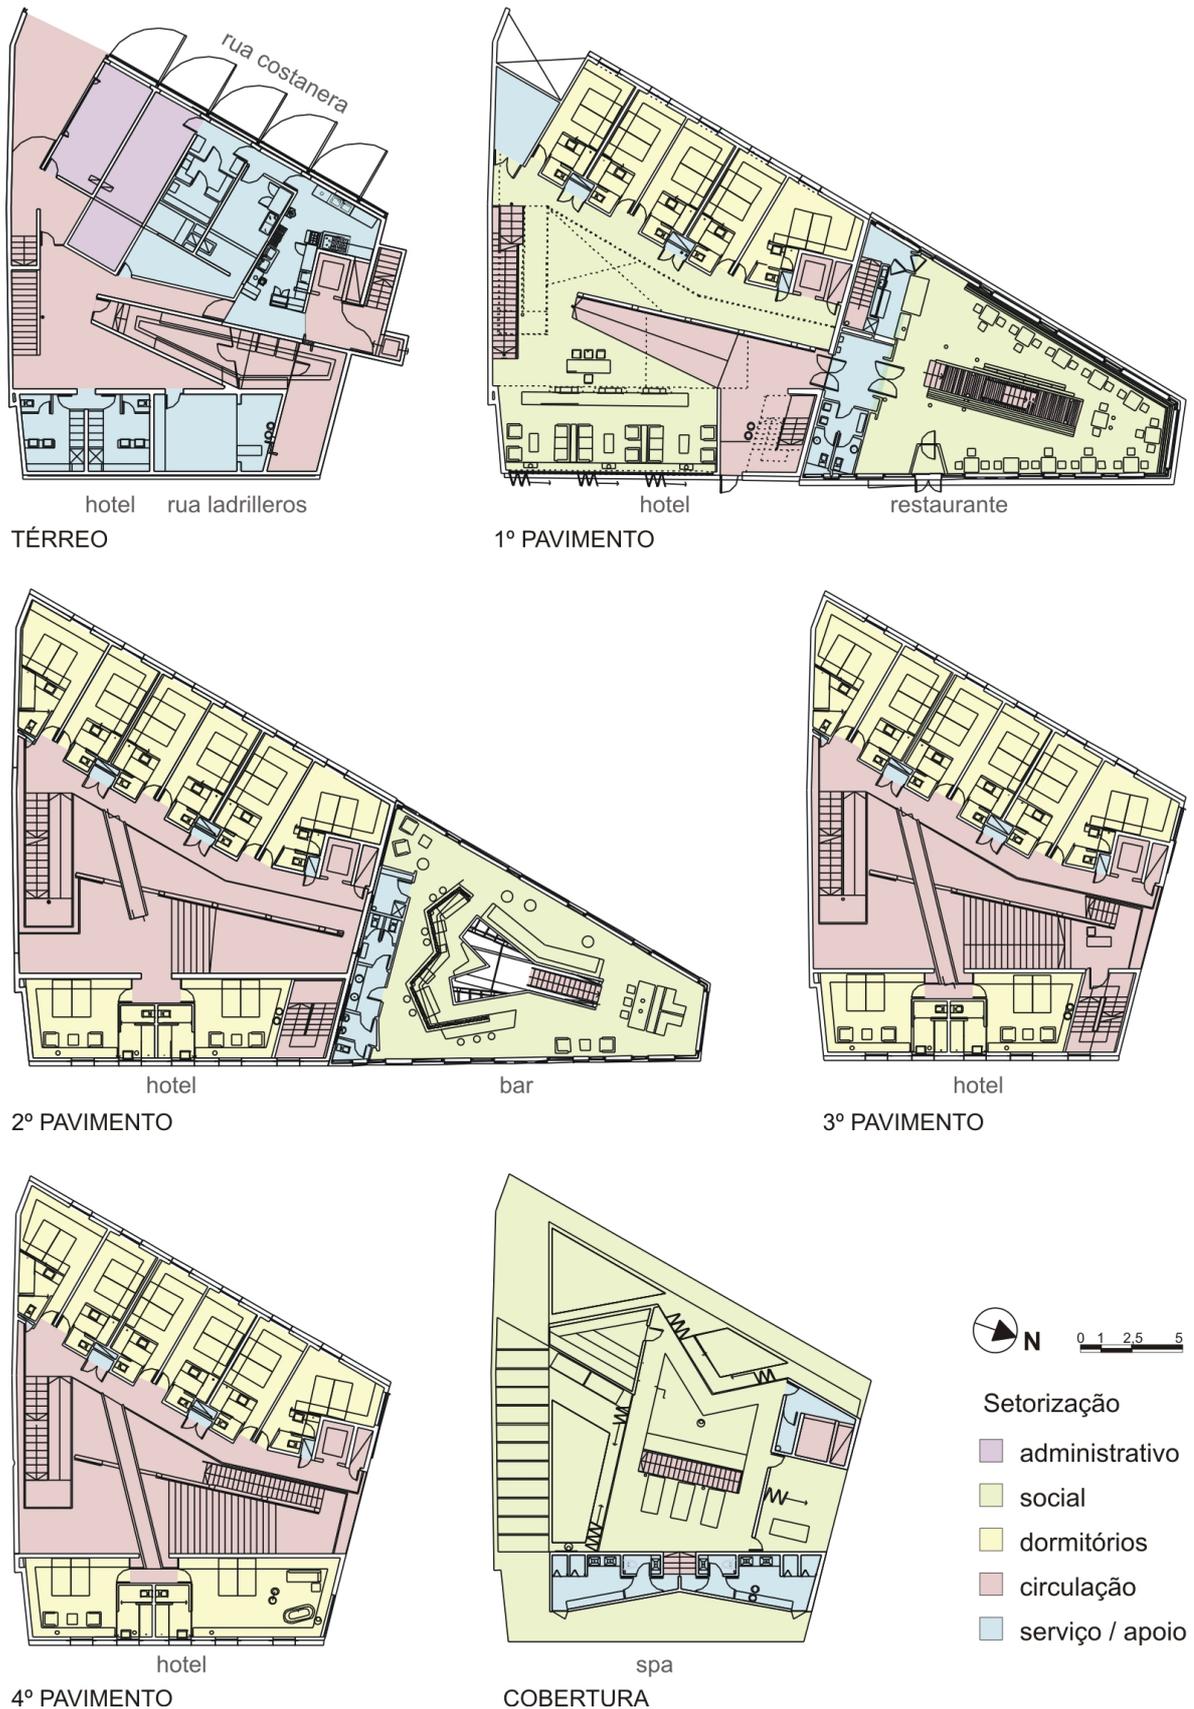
Plantas Térreo, Primeiro ao Quinto Pavimento e Cobertura do Indigo Hotel
